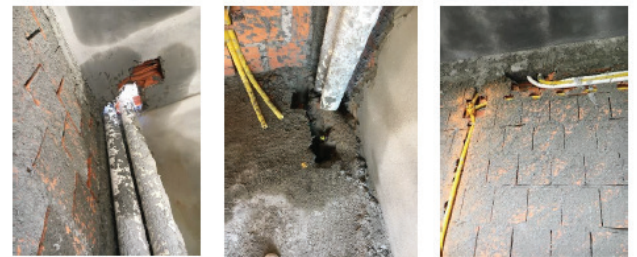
Interferências entre as disciplinas em canteiro de obras: (a) e (b) furo na laje e (c) furo na viga para tubulações
